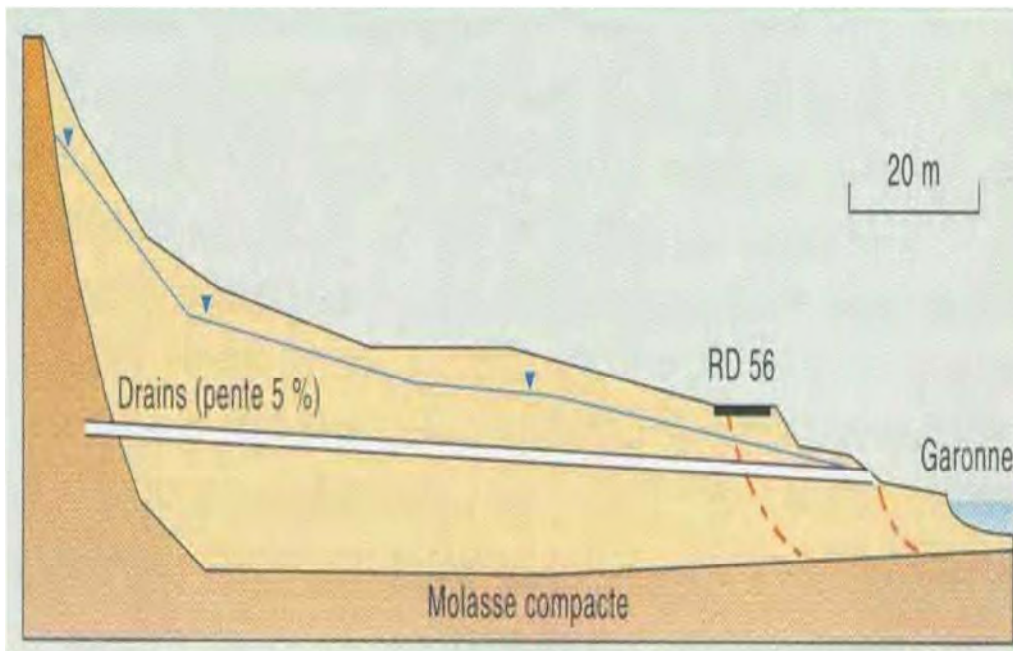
Stabilisation de la RD 56 à Muret (Haute-Garonne).
